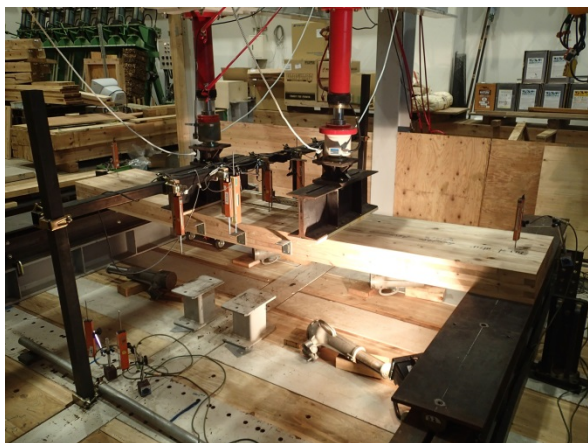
面外曲げ試験状況 (幅 600mm)
